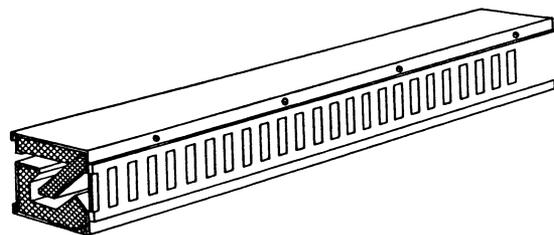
b: Beispiel eines Schalldämmlüfters zum Einbau unter Fenster.
